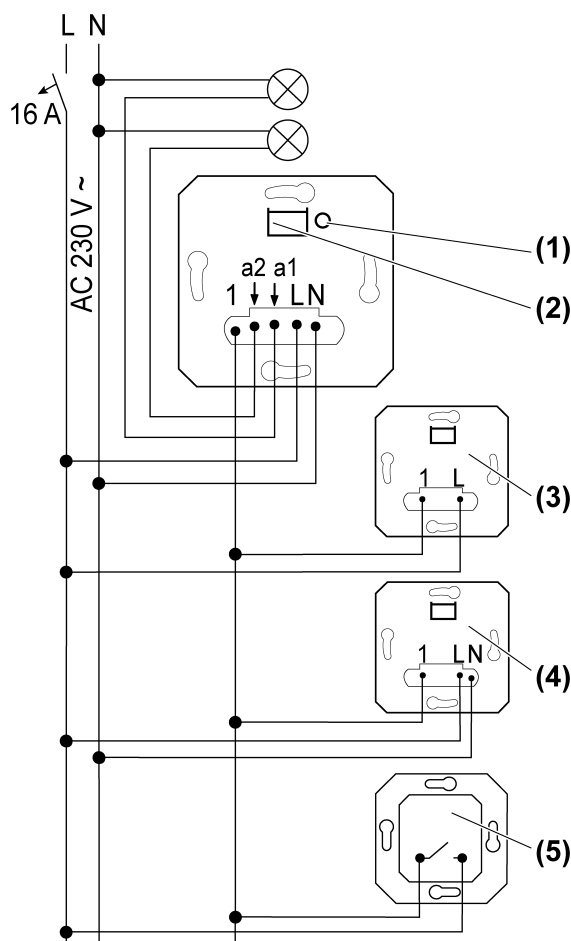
Plan de conexión con mecanismos auxiliares opcionales
